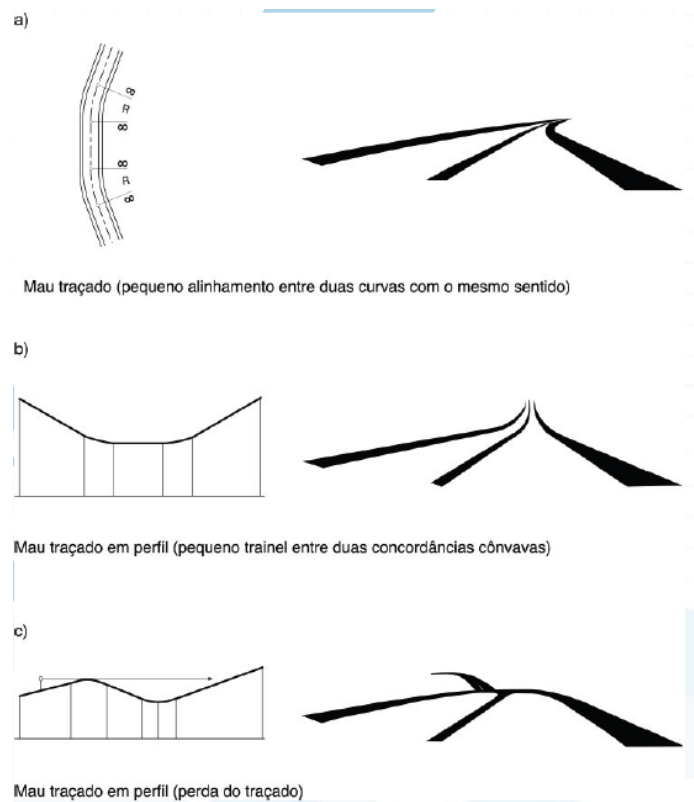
Coordenação do Traçado em Planta e Perfil 2 (Fonte: fig. 12B, [18] ou [19])
